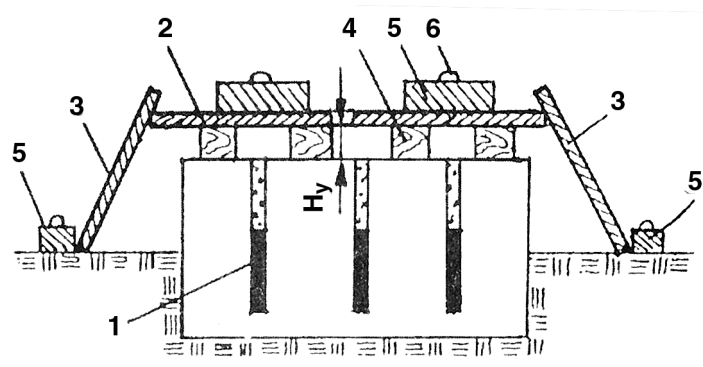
Схема окопки разрушаемого взрывом фундамента:
